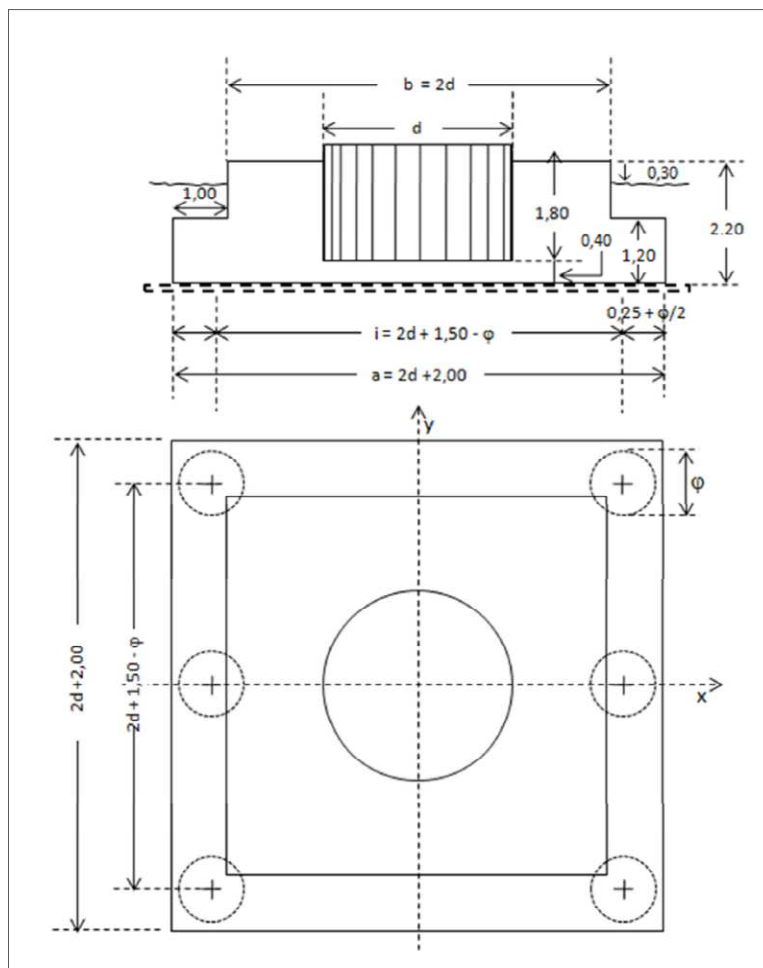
Schema tipo di fondazione profonda su n. 6 pali trivellati.
